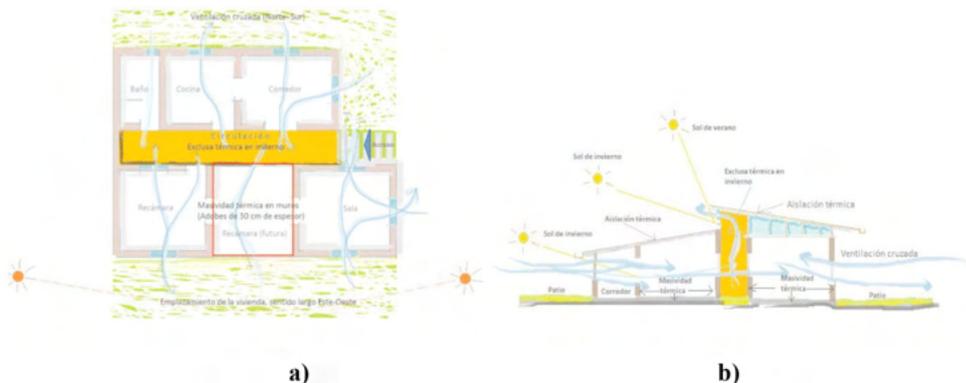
Estrategias de diseño bioclimático: a) Planta arquitectónica, b)sección transversal
